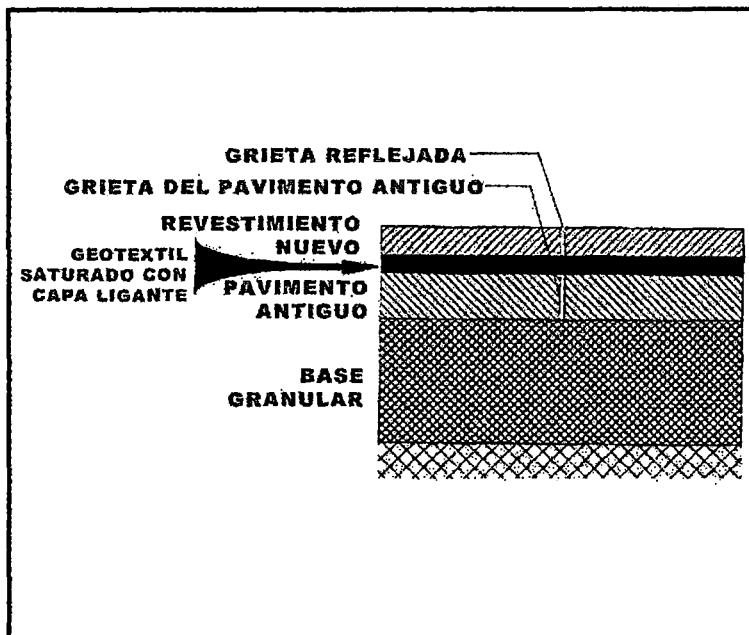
GEOTEXTIL DE BARRERA, PARA REAFIRMAR PAVIMENTOS DE CARRETERA
